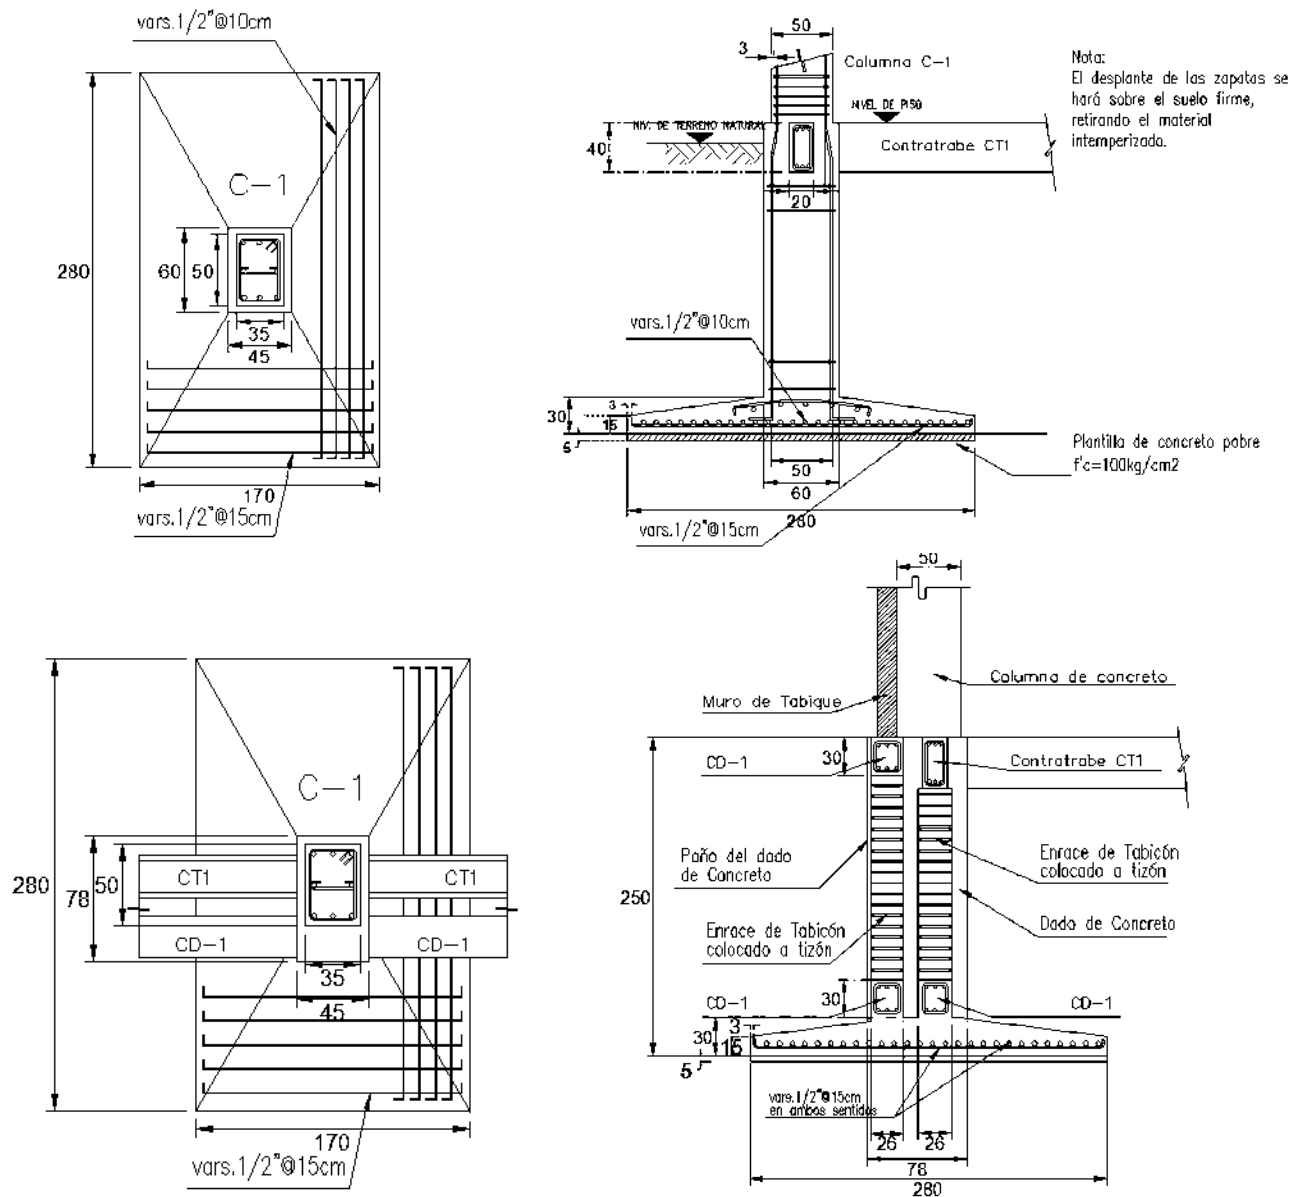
(planta y alzado de las zapatas aisladas del Campus Zamora).
